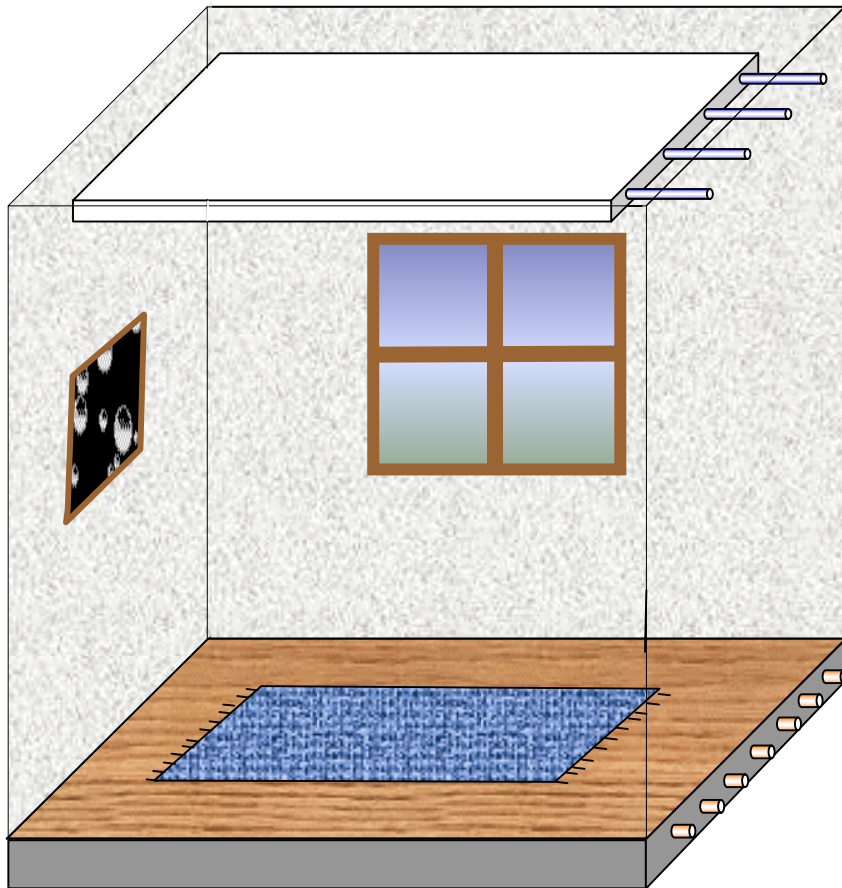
Wohnraum mit Deckenkühlung und Fußbodenheizung
